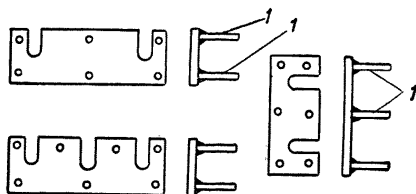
Стальная плита для равномерной передачи реактивных усилий от предварительно напряженной арматуры
